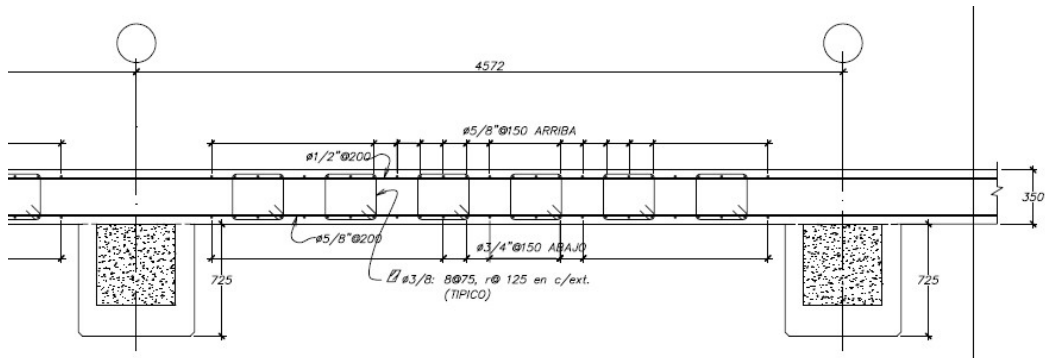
Armadura típica de losa de los amarraderos 3A y 3B - Sección longitudinal
